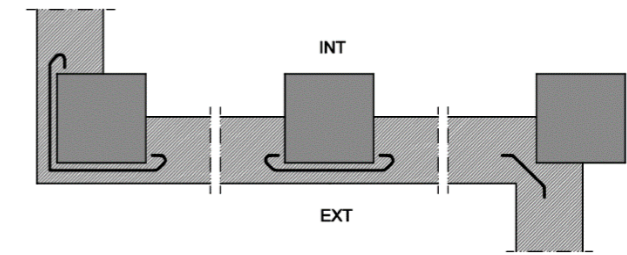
Ejemplo de encuentro de la fachada con los pilares
